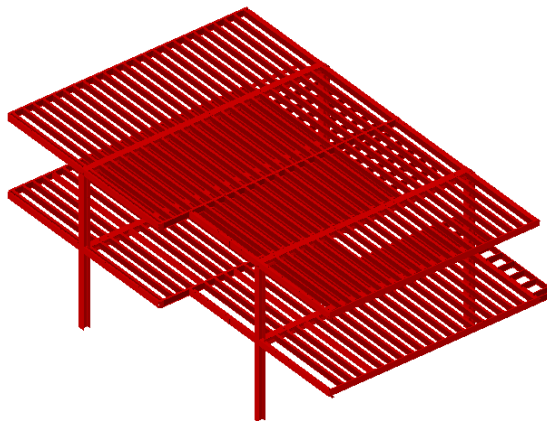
Sistema Metálico Misto (LSF + Construção metálica tradicional) – Pórtico + Vigas de pavimento
